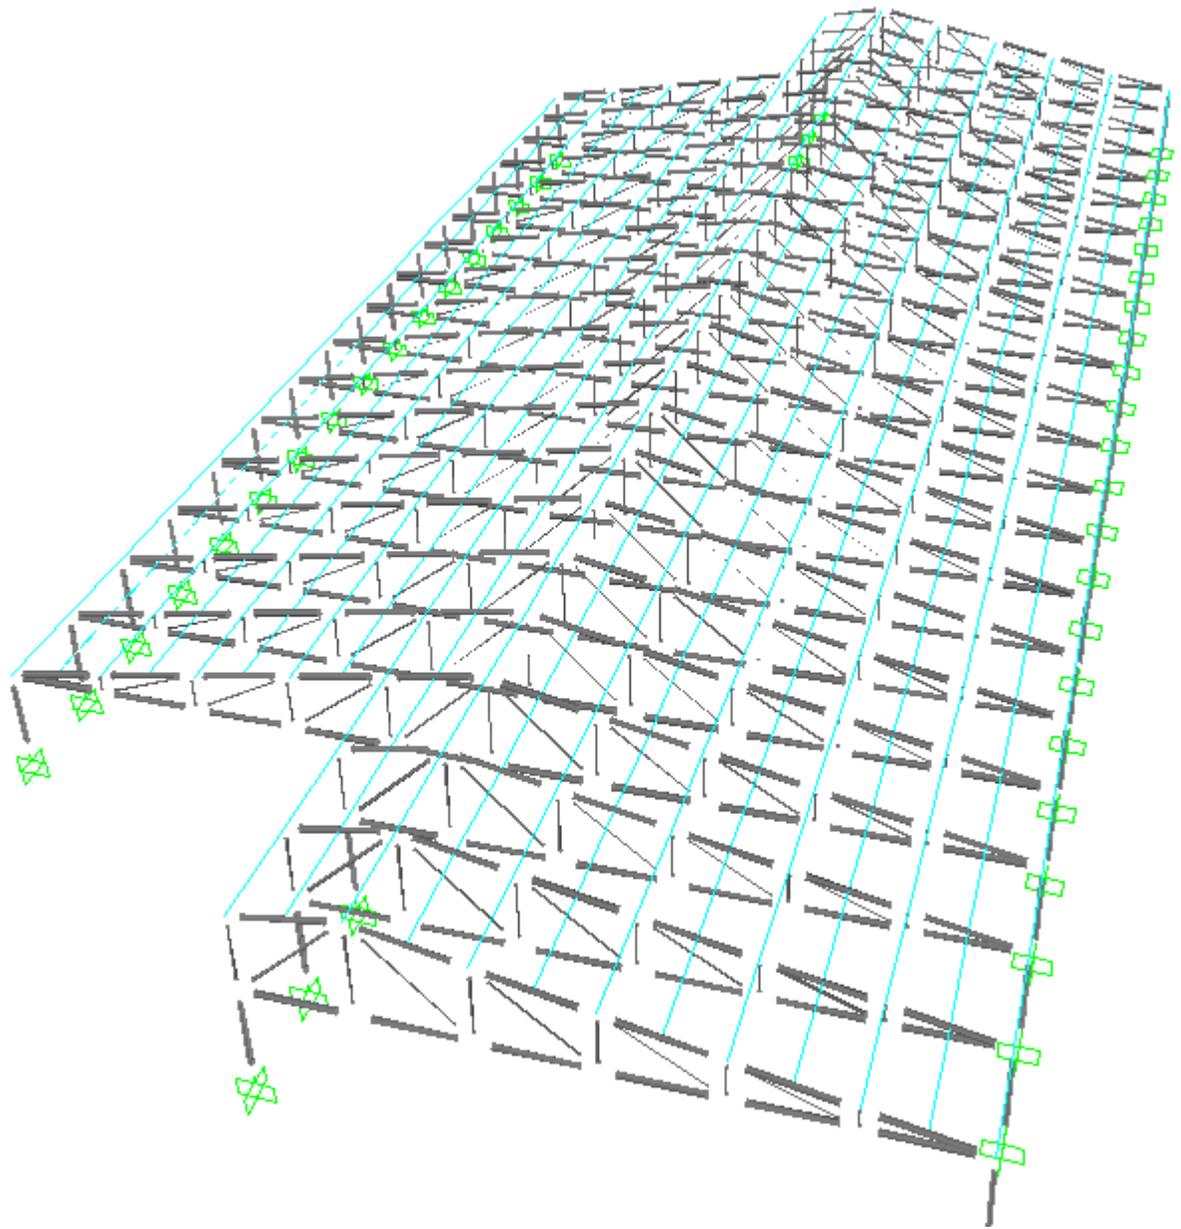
Vista de los nodos de las armaduras trabajando como articulaciones.
